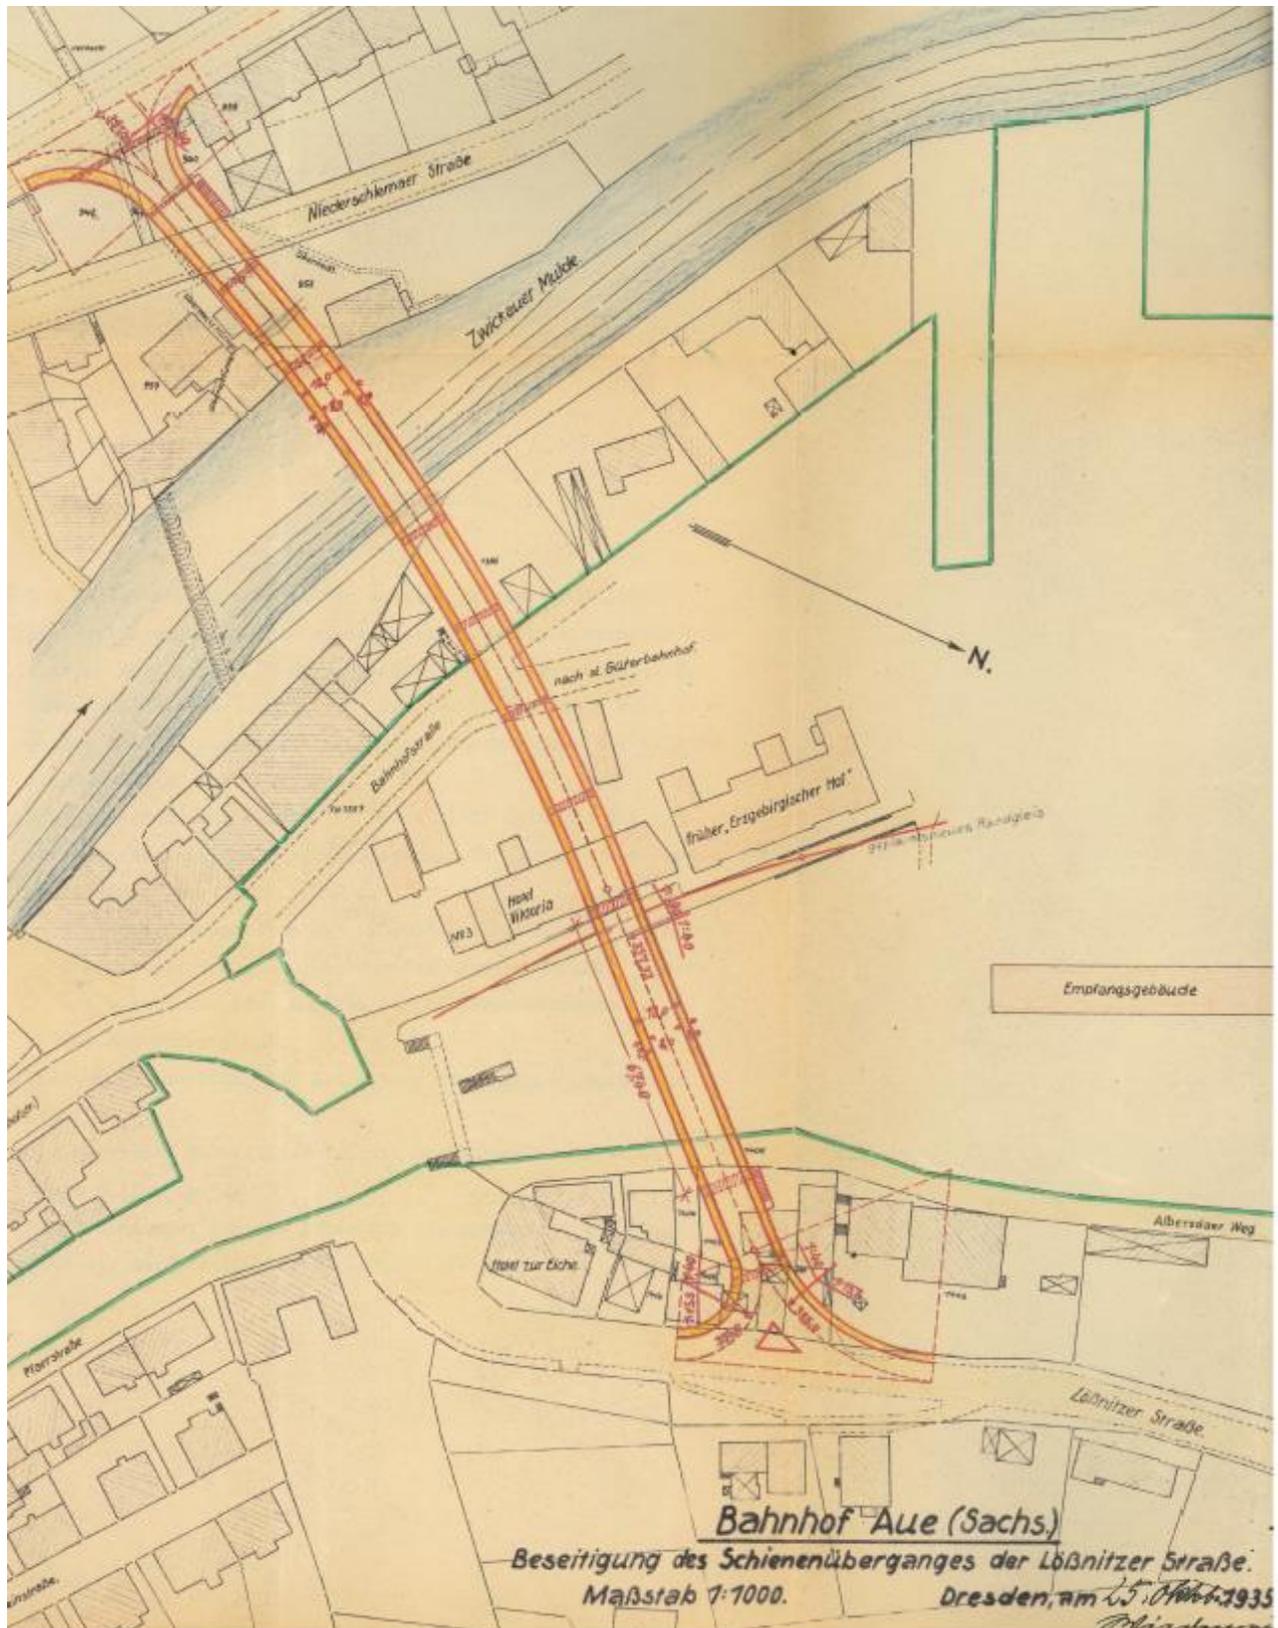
Anlage 1 zur Eisenbahnkreuzungsvereinbarung vom 25.10.1935-Lageplan M 1:1.000
